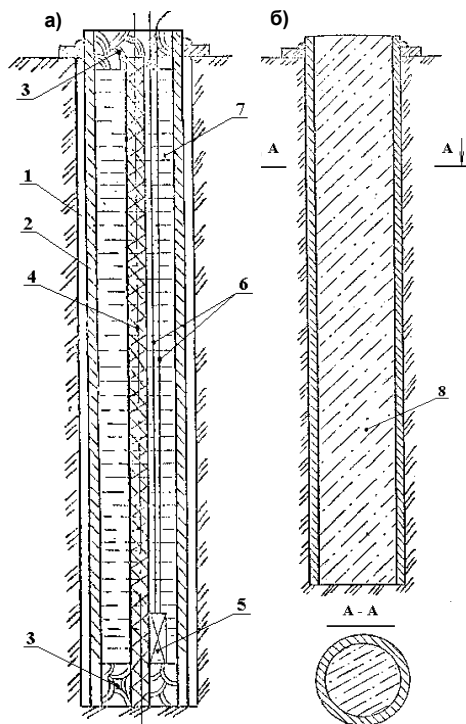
Конструкция снаряженной взрывчатким веществом трубной заготовки (а) и трубчатого анкера ТА2 (б): 1 – шпур; 2 – трубная заготовка; 3 – глиняная пробка; 4 – детонирующий шнур ДША или ДШВ; 5 – электродетонатор; 6 – электропровода; 7 – наполнитель (песок, вода); 8 – расширяющийся при твердении раствор
